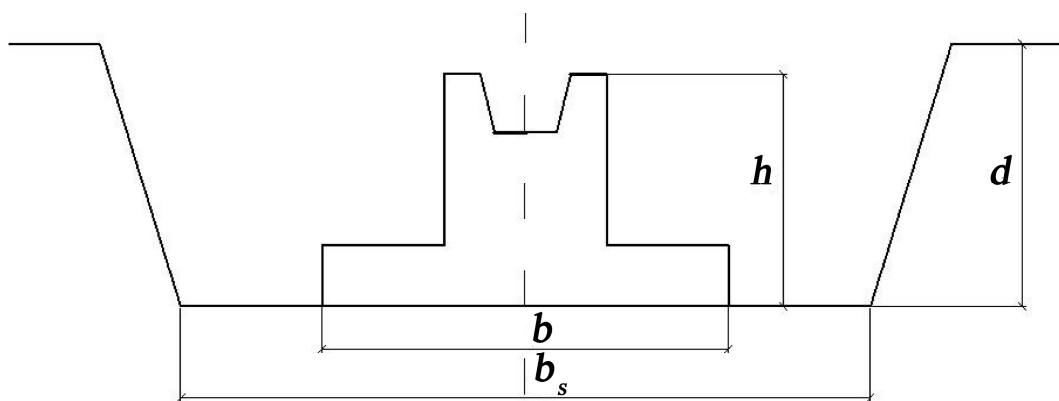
Фундамент на предварительно уплотненном грунте
